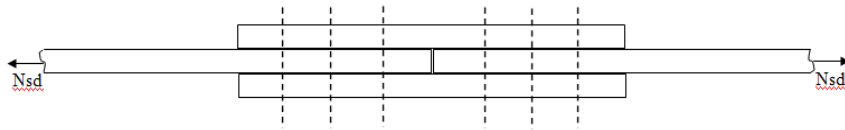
Assemblage bout à bout par couvre joint (vu de dessus).
